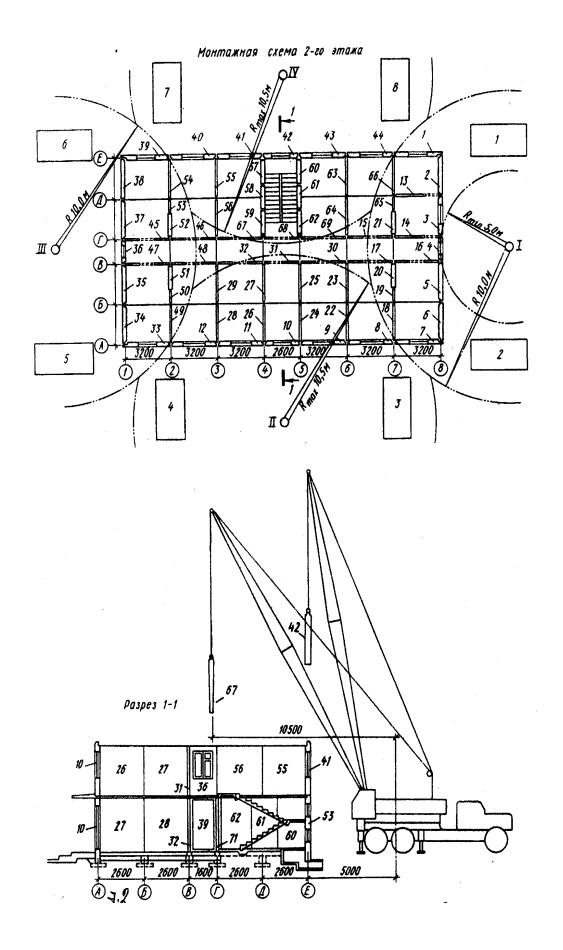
Схема монтажа стеновых панелей, второго этажа здания общежития
